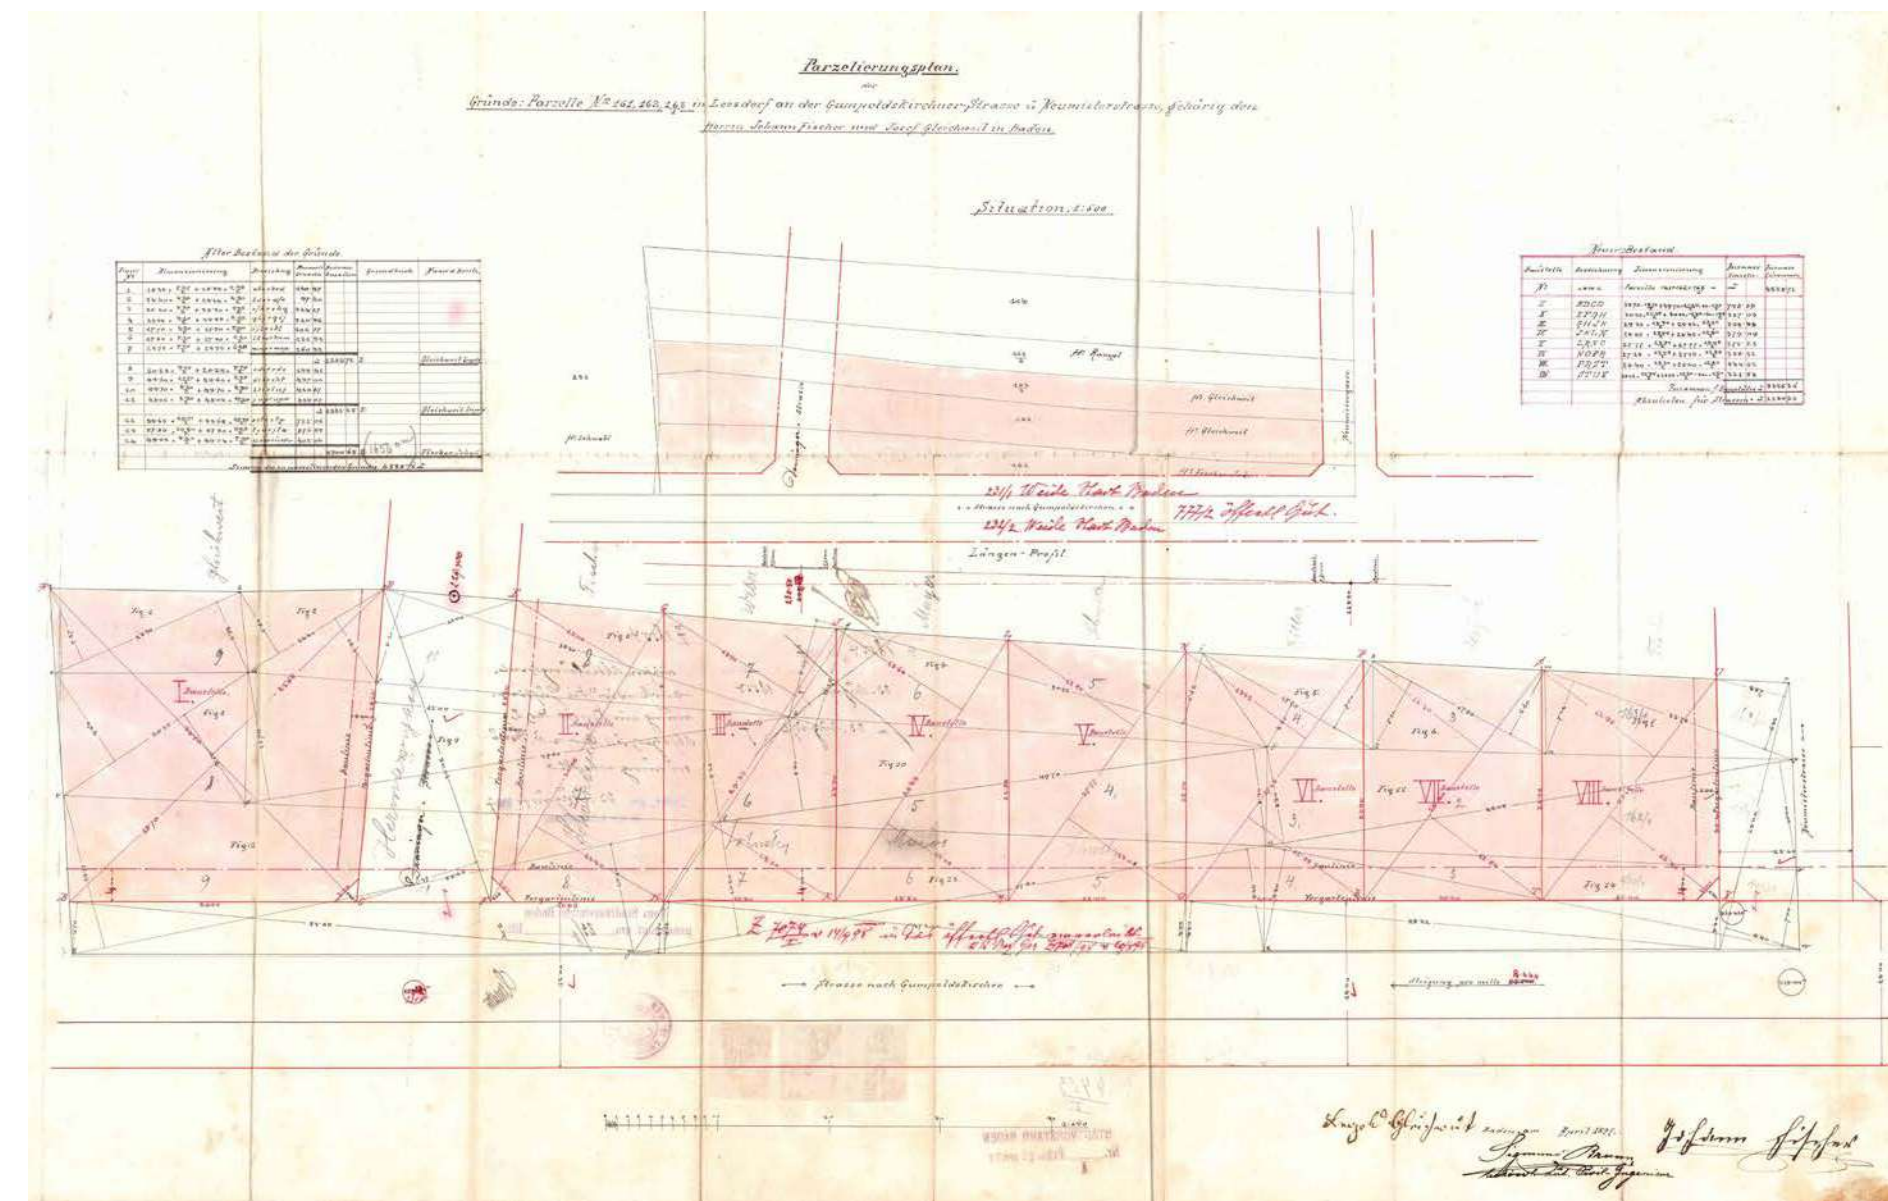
Parzellierungsplan des Häuserblocks Germergasse 34-44 vom April 1897.
